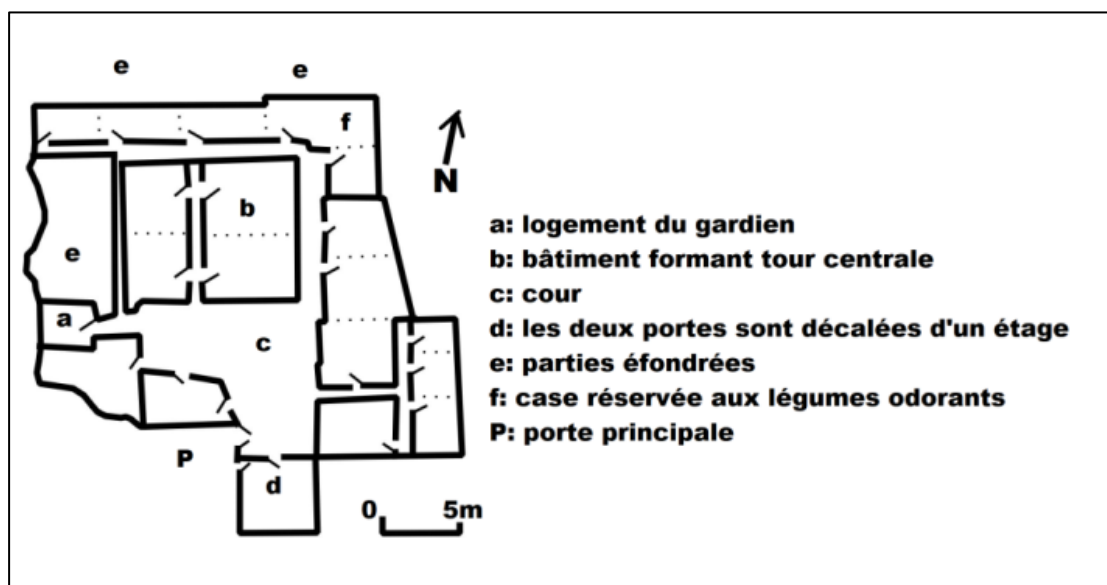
Plan d'un grenier collectif à Arris "Guelâa d'Inerkeb".
